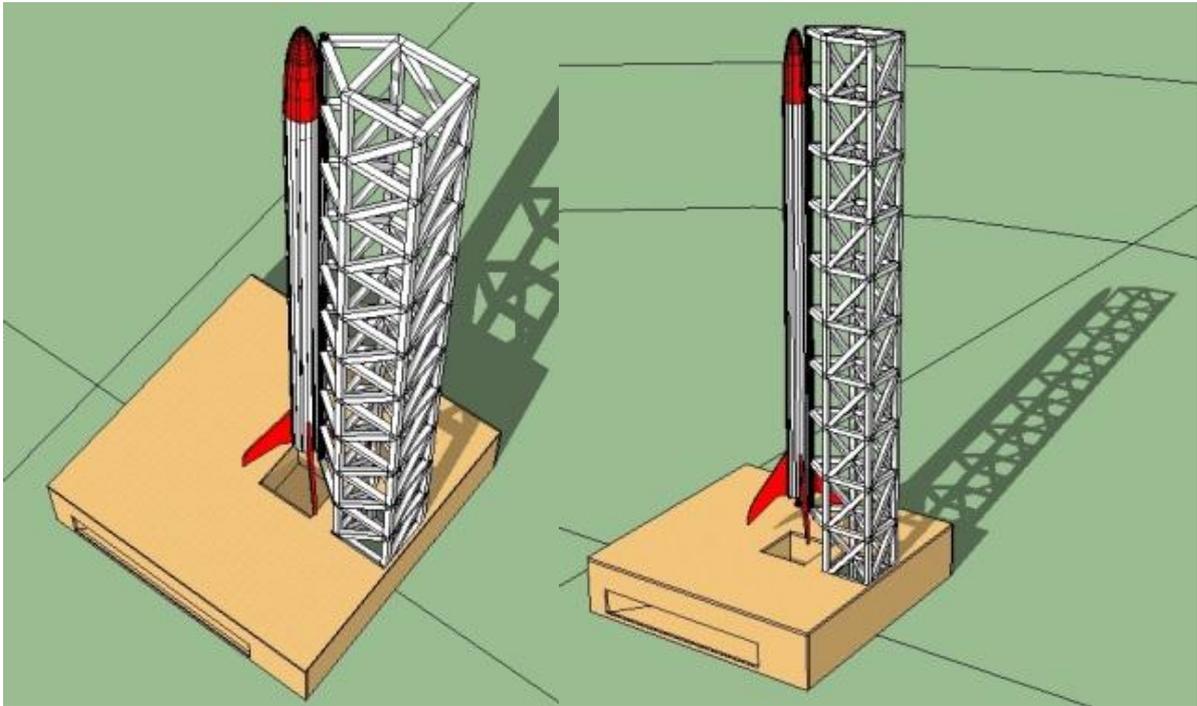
Vista tridimensional de la Plataforma de Lanzamiento
